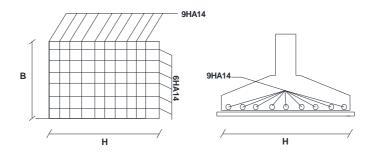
Schéma de ferraillage de la semelle de poteau.
